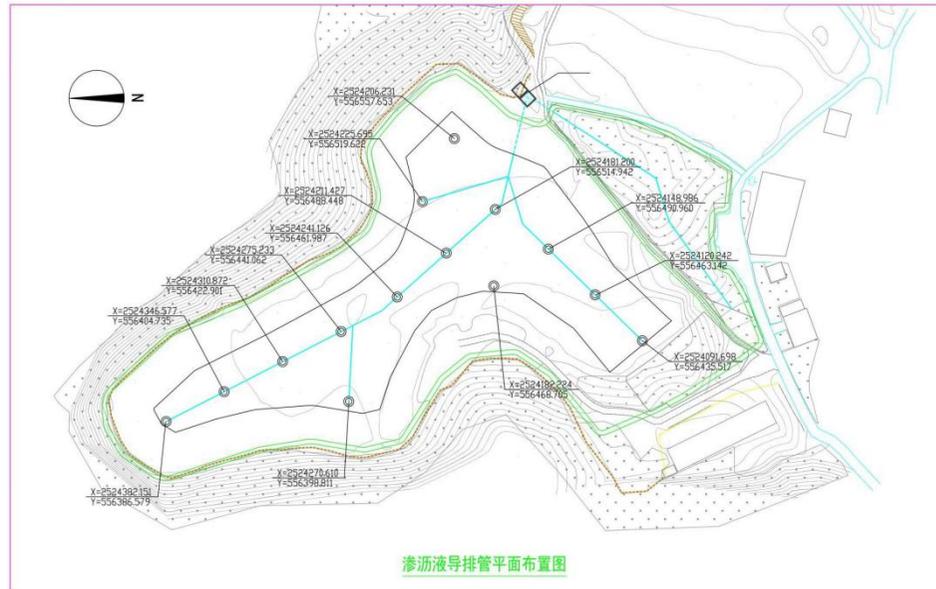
项目平面图 (现有渗滤液导排平面布置图)
